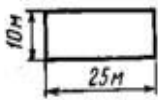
План прямоугольного котлована: 10 и 25 – размеры дна котлована в плане
